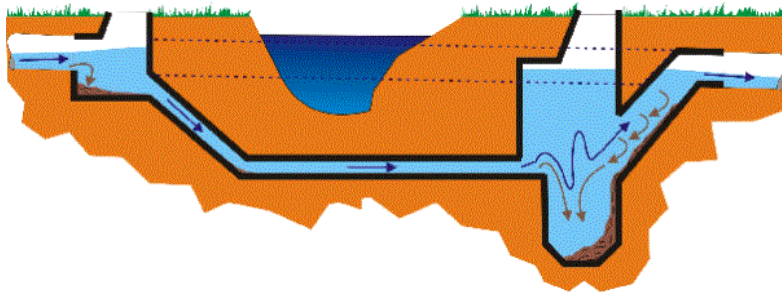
Fonctionnement d'un siphon ; le siphon « bourre ».
